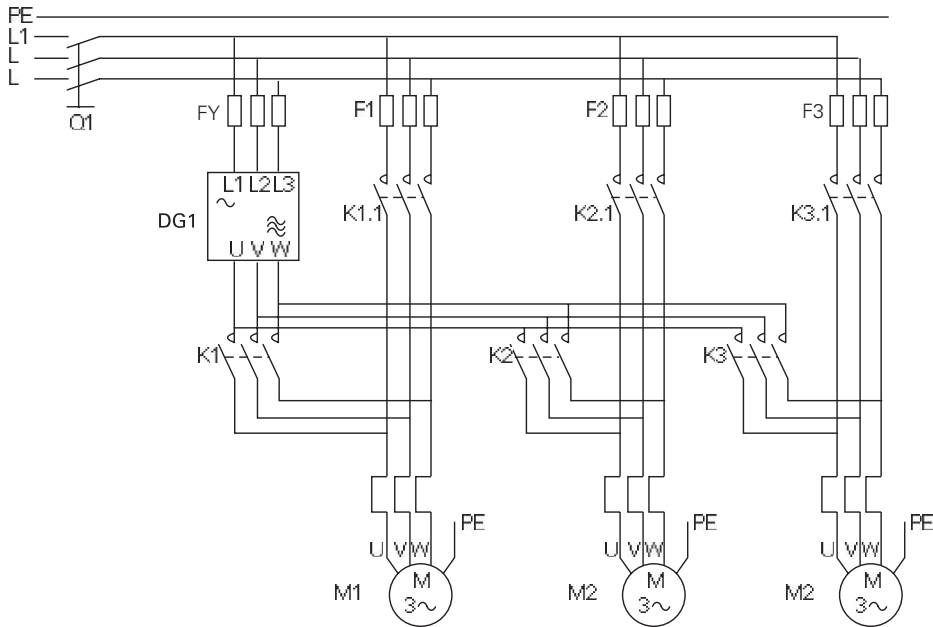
Beispiel einer Pumpensteuerung mit drei Pumpen, Steuerstromlaufplan
